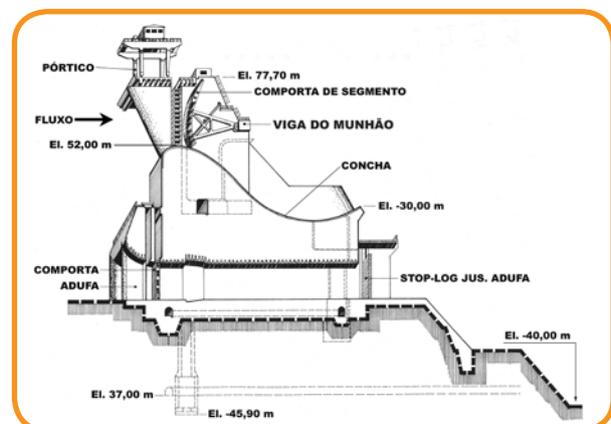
Seção transversal de um bloco típico do Vertedouro.
